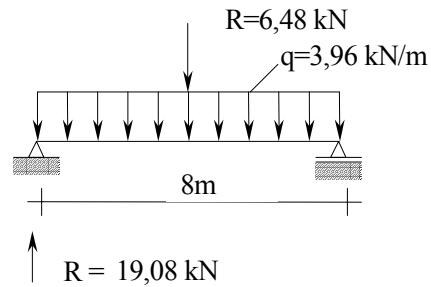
Esquema estrutural da viga V4-Análise estática
